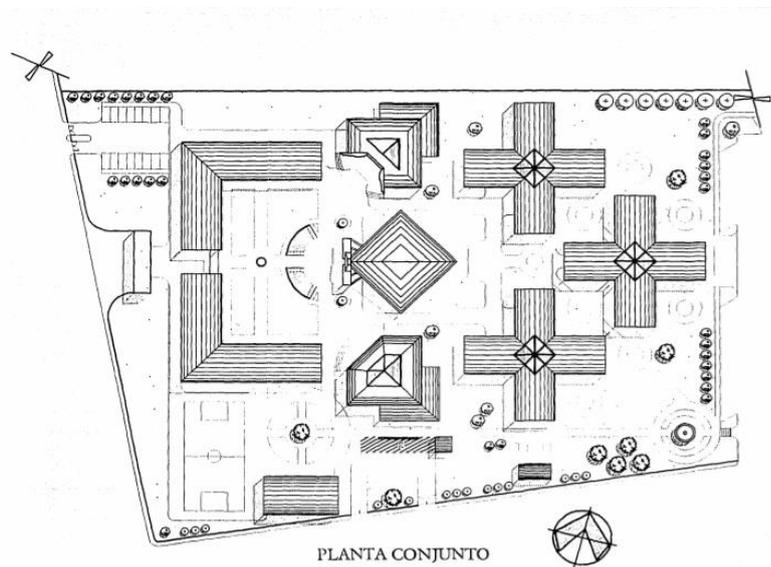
Planta conjunto del Seminario Mayor de Texcoco.
